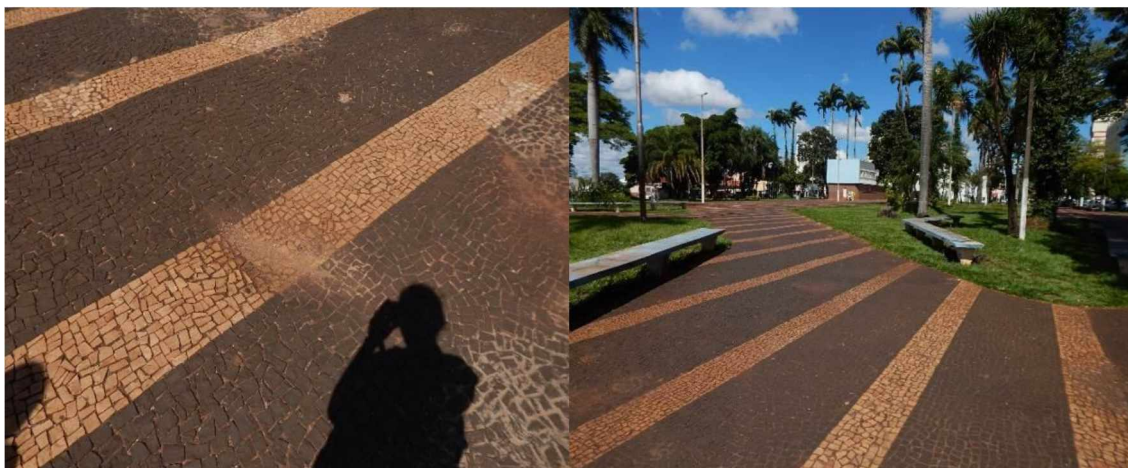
Estrutura da praça Getúlio Vargas (Praça da 26)
